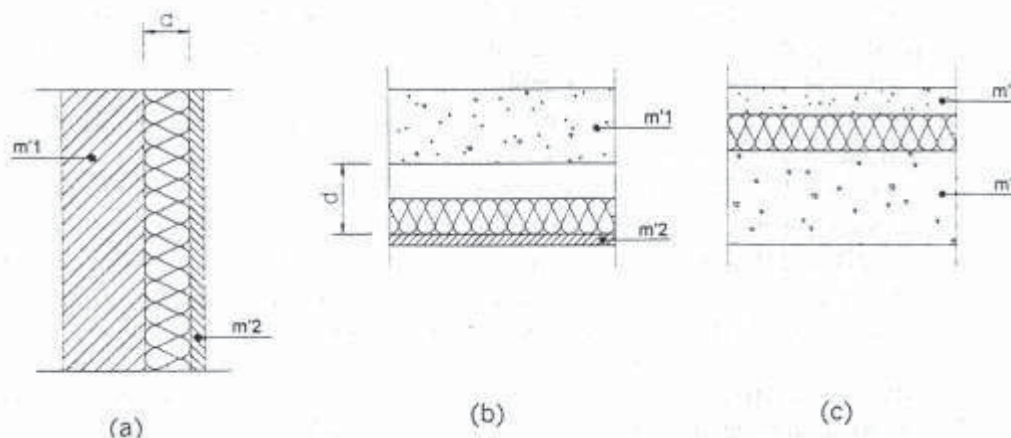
Incremento del potere fonoisolante mediante l'applicazione di uno strato addizionale su un divisorio in muratura: a) divisorio verticale con controparte; b) solaio con controsoffittatura; c) pavimento galleggiante.
